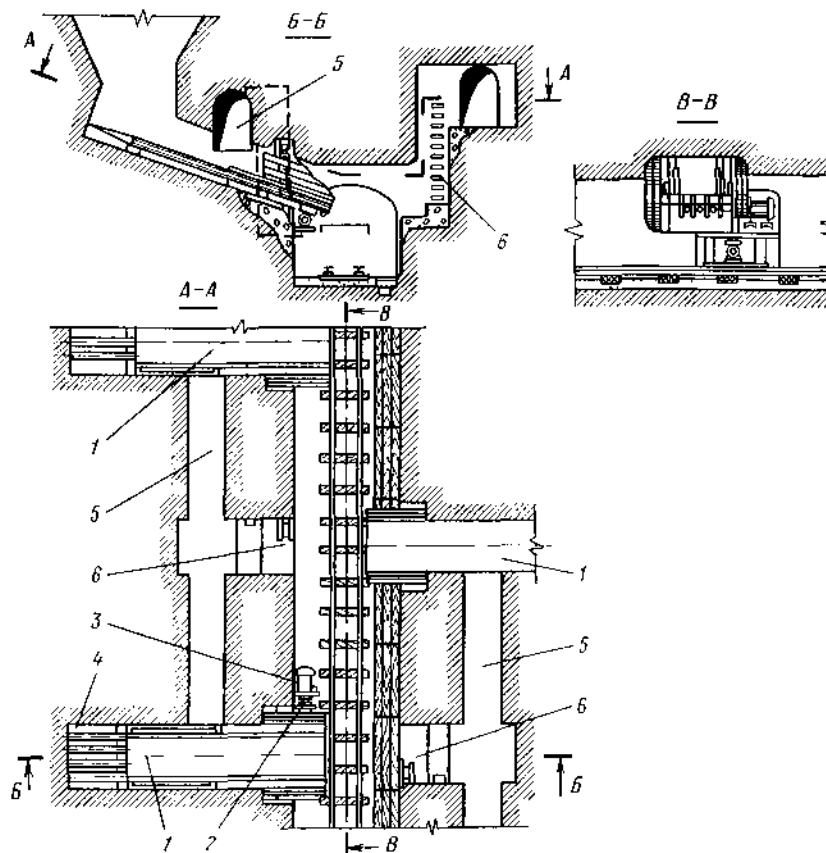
Схема установки вибропитателя с торцевой загрузкой'
